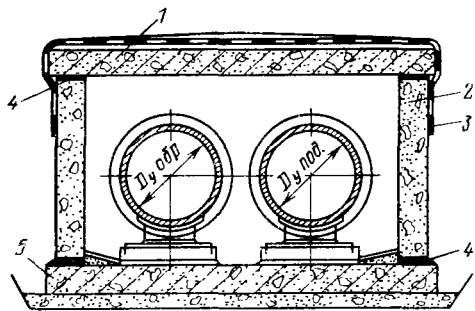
Канал из сборных железобетонных плит и бетонных стеновых блоков:
